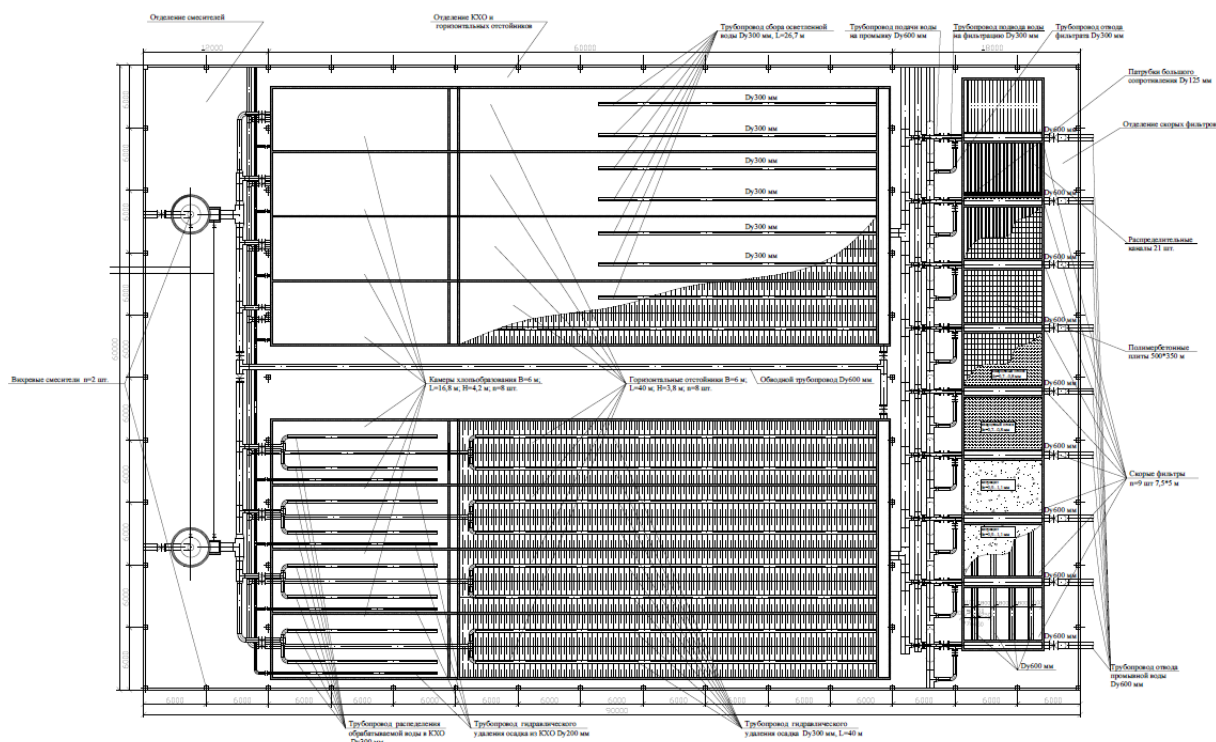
План главного корпуса Севастопольских ВОС 2-го бока
